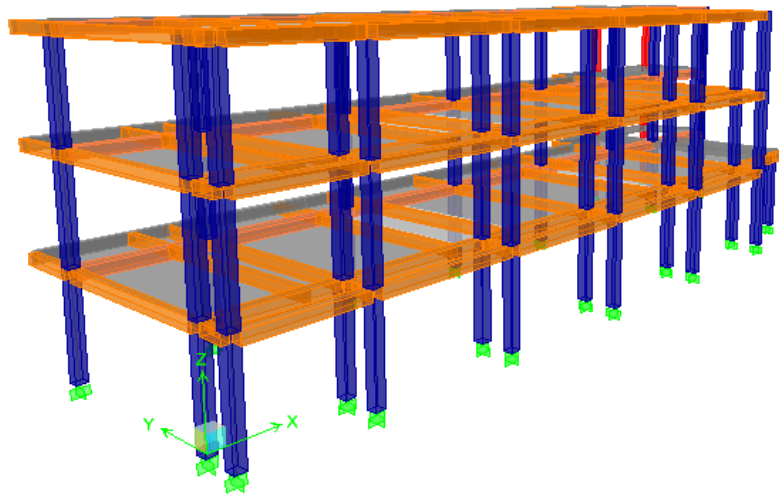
Sistema Reforzado con Pórtico Adosado – Vista 2
